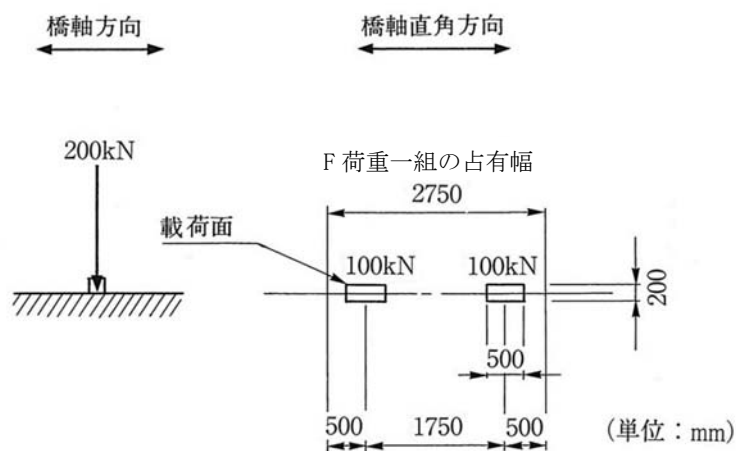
疲労設計荷重 (F 荷重) の標準
